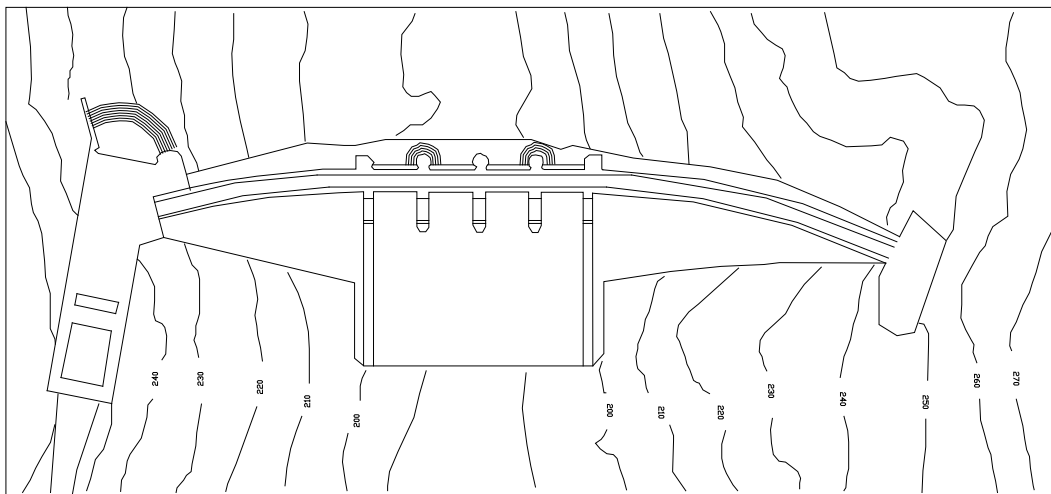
Planta de la estructura de la presa Torrejón Tajo. Escala 1:2900.
